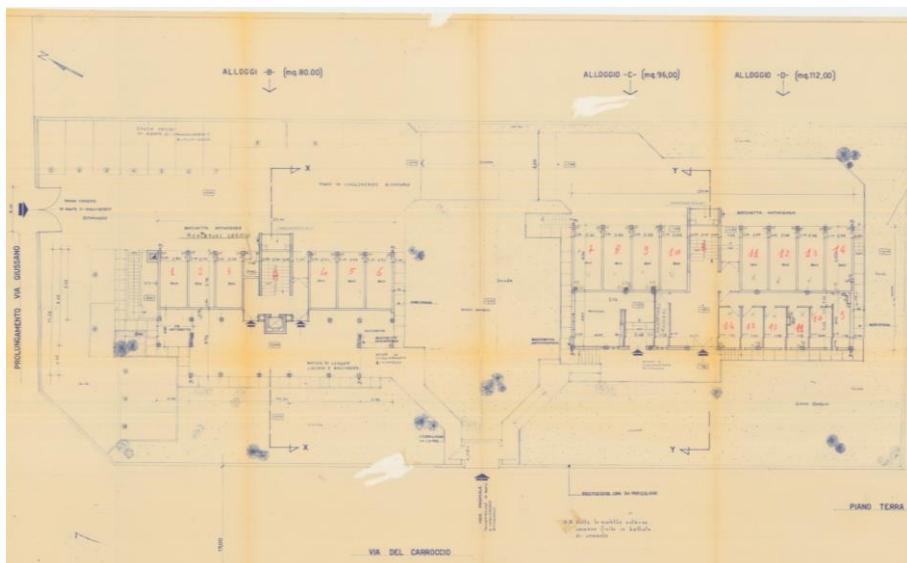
, Pianta Piano Terra, scansione progetto originale
